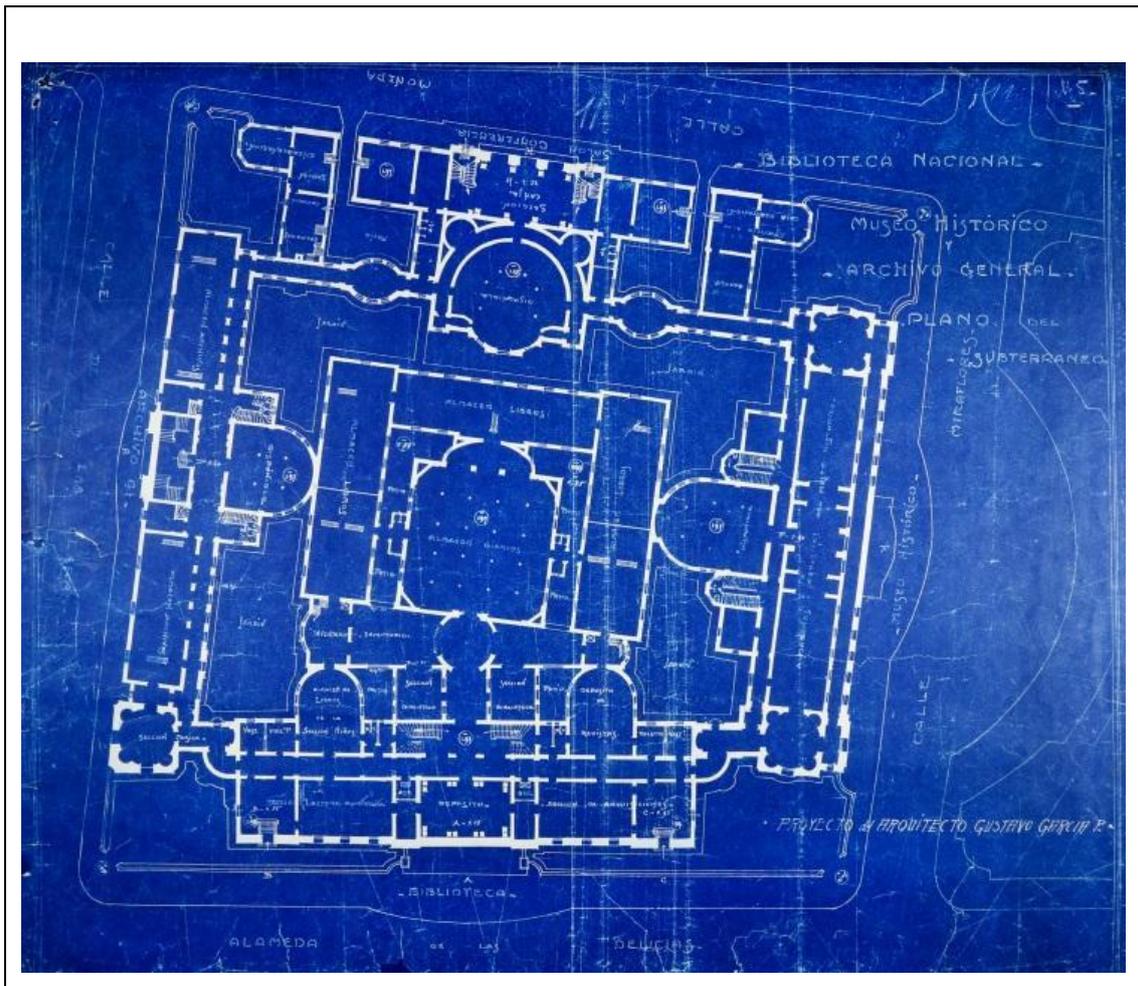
PLANO DEL PROYECTO ORIGINAL, DONDE SE APRECIA LA PLANTA DE TODOS LOS EDIFICIOS QUE SE CONSTRUIRÍAN EN EL TERRENO. COLECCIÓN ARCHIVO NACIONAL (ARCHIVO NACIONAL, S.F.-H)
